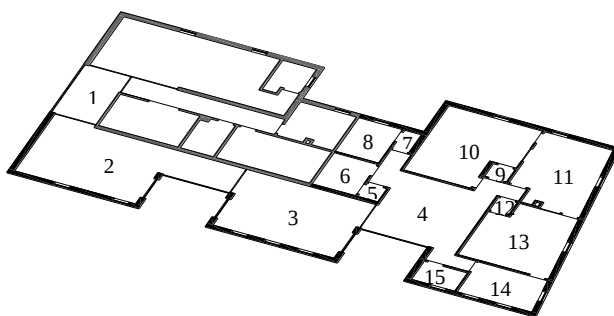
| Planta esquemática do Piso Térreo, Imagiologia.
